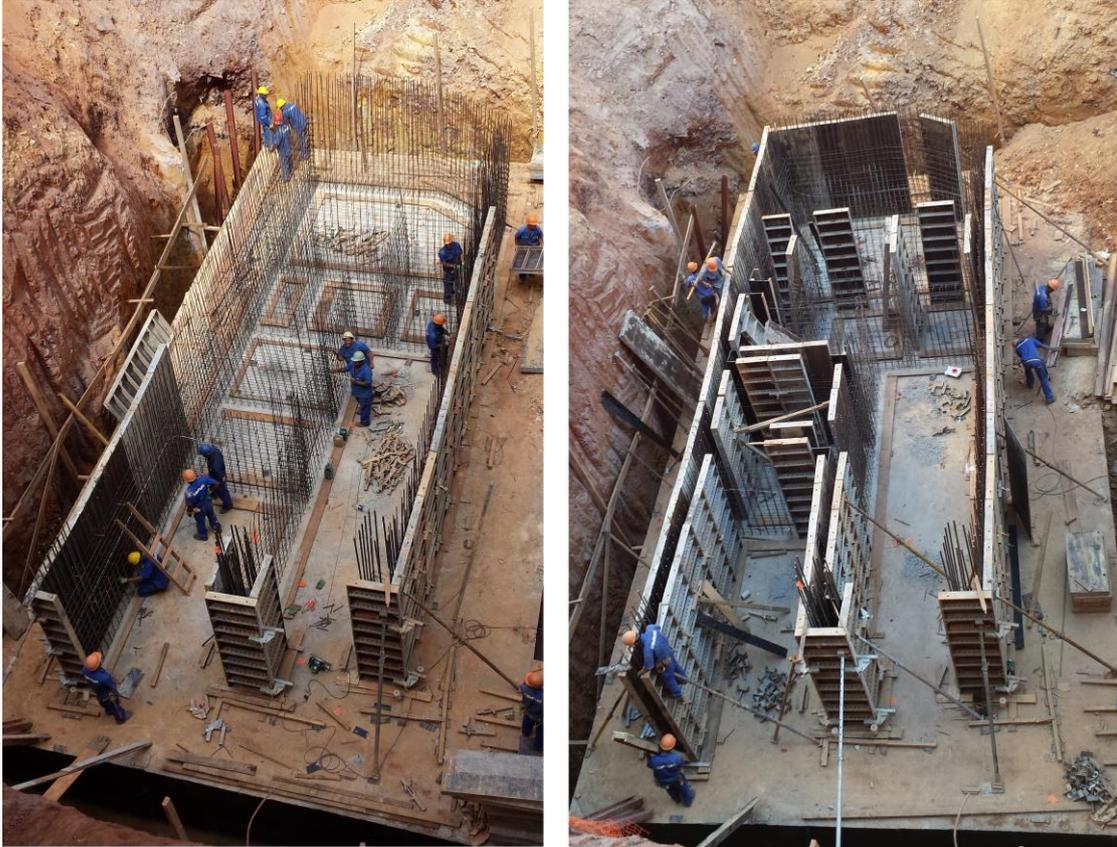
Armadura dos pilares (esq.) e Concreform (dir.)
